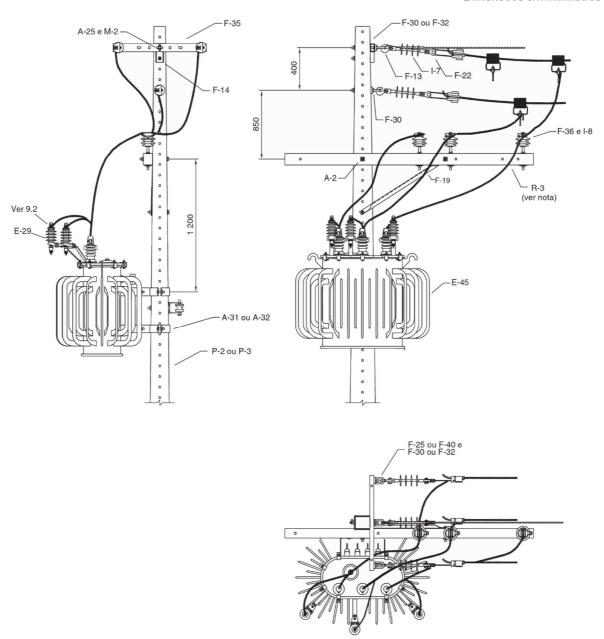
Estrutura CE3 TR AP – Poste de concreto de seção DT ou de madeira
